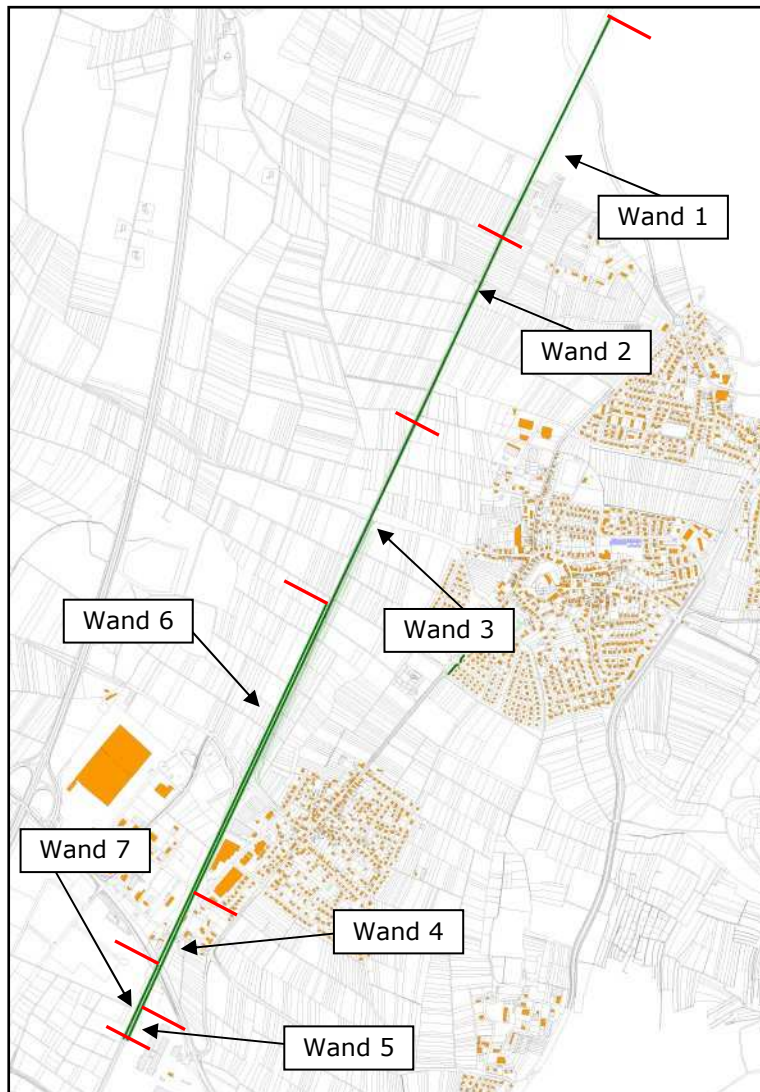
Lärmschutzwände - Antragstrasse 2025 Variante 1
